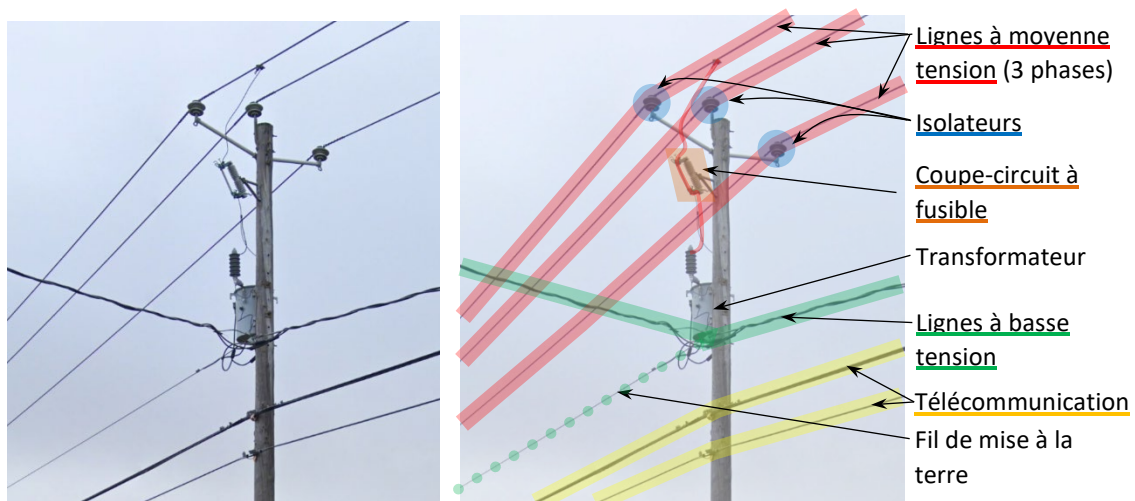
Exemple général n° 2 ([lien Google Street View](#))
